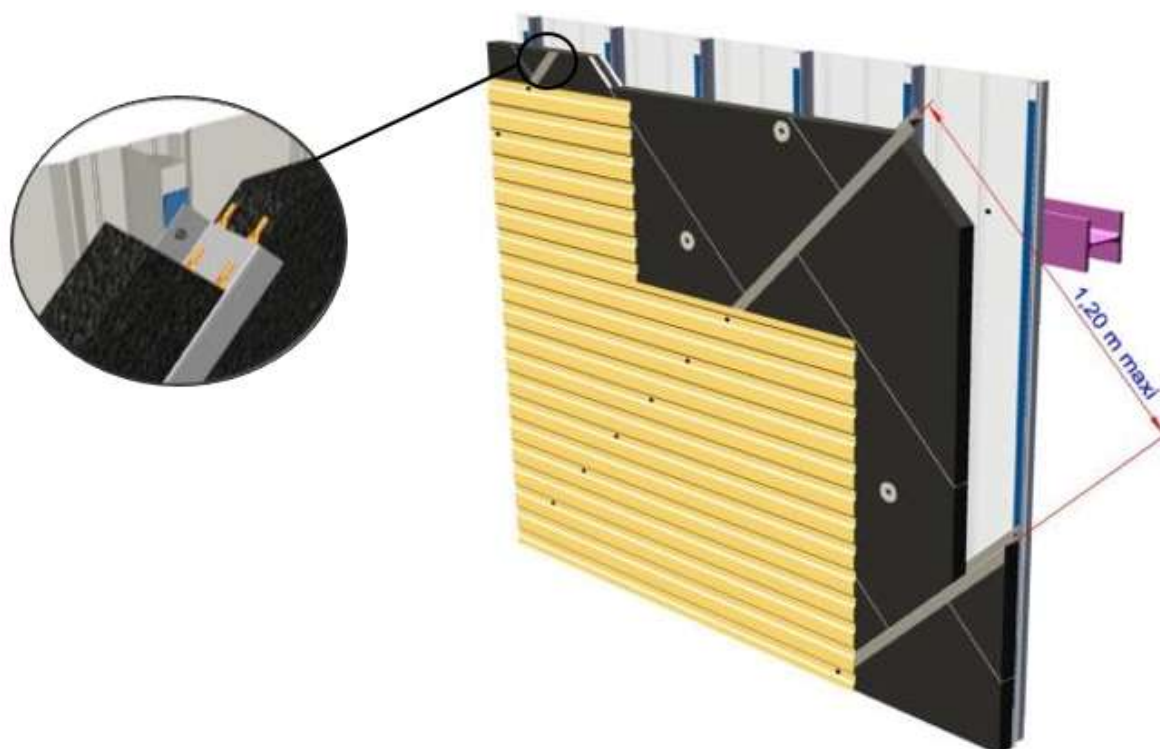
Vue en perspective avec détail (exemple : plateaux verticaux avec Z à 45° et peau d'étanchéité horizontale)
